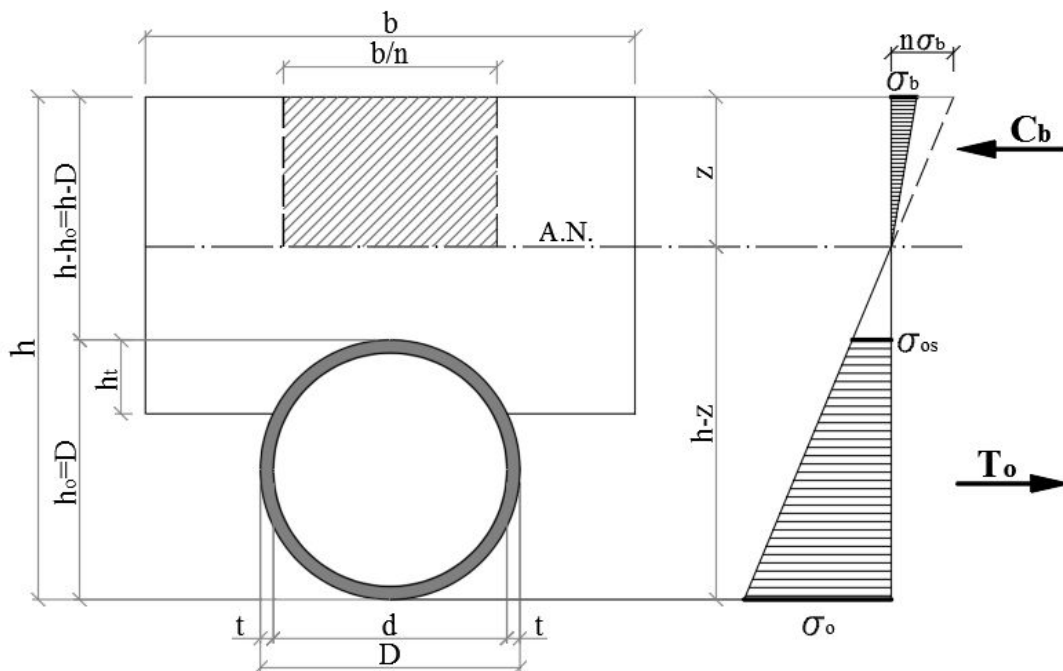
1. Model de calcul pentru structură mixtă oțel-beton cu structura metalică din țevi de oțel distanțate
